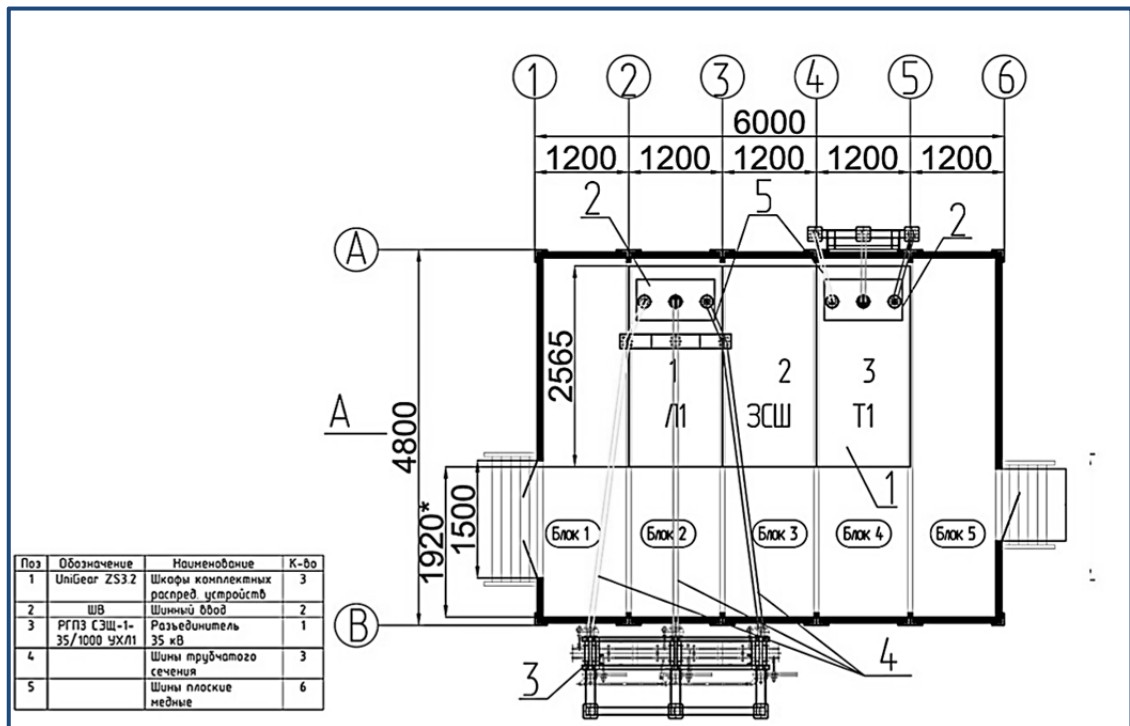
План расположения электрооборудования КРУ-35 кВ в блочно-модульном здании
